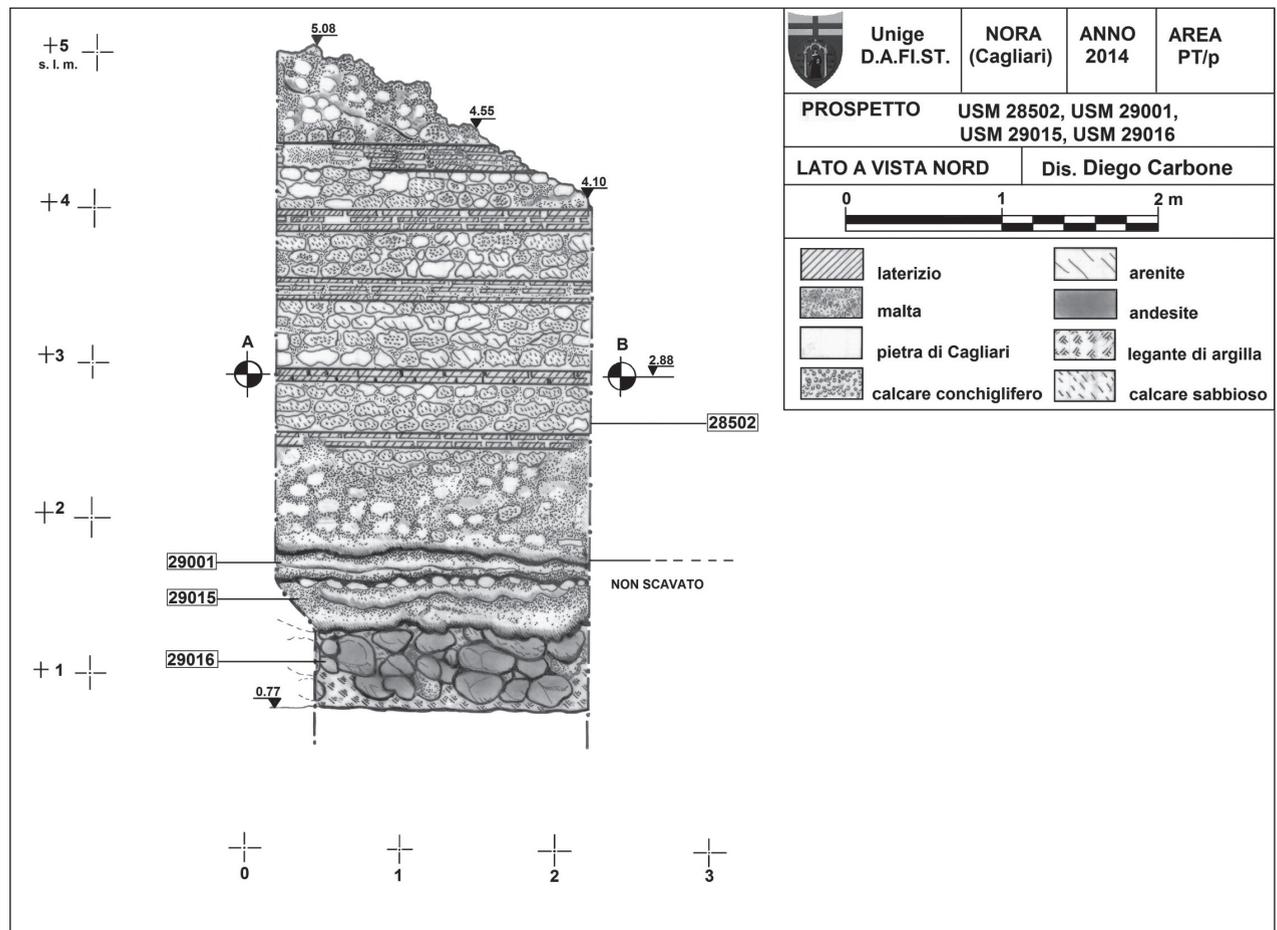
Nora, Area PT/p. Prospetto del muro S del *prae-furnium*.
